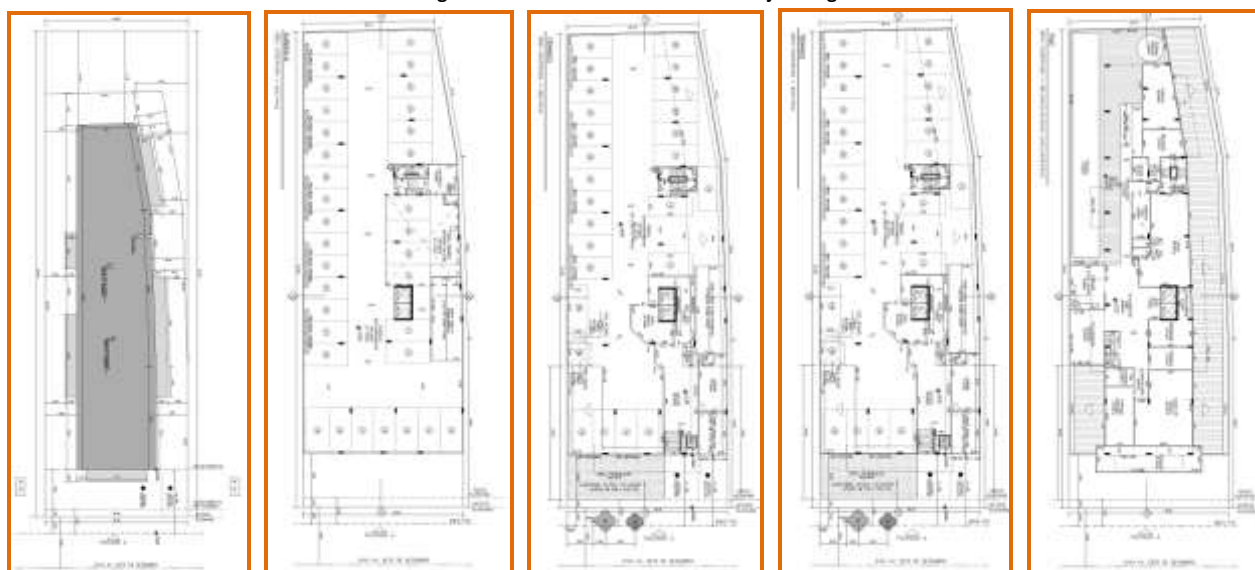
Implantação, subsolo, semienterrado, térreo, PUC – Fonte: Projeto Legal
